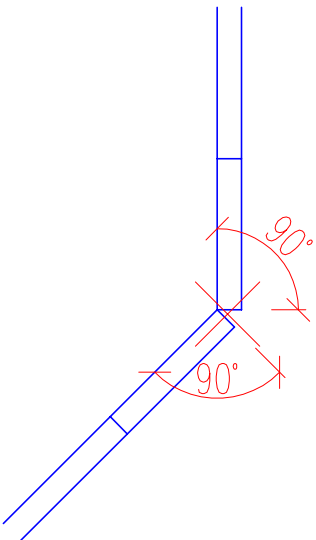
DETAIL NAVÁZÁNÍ OBRUBNÍKŮ VE SMĚROVÝCH LOMECH
